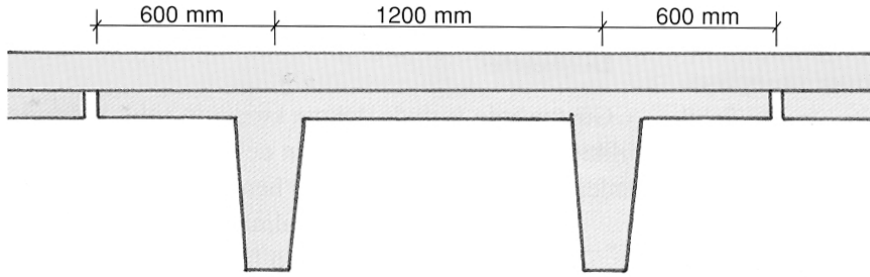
Normal donatılı prefabrike betonarme döşeme [23].
